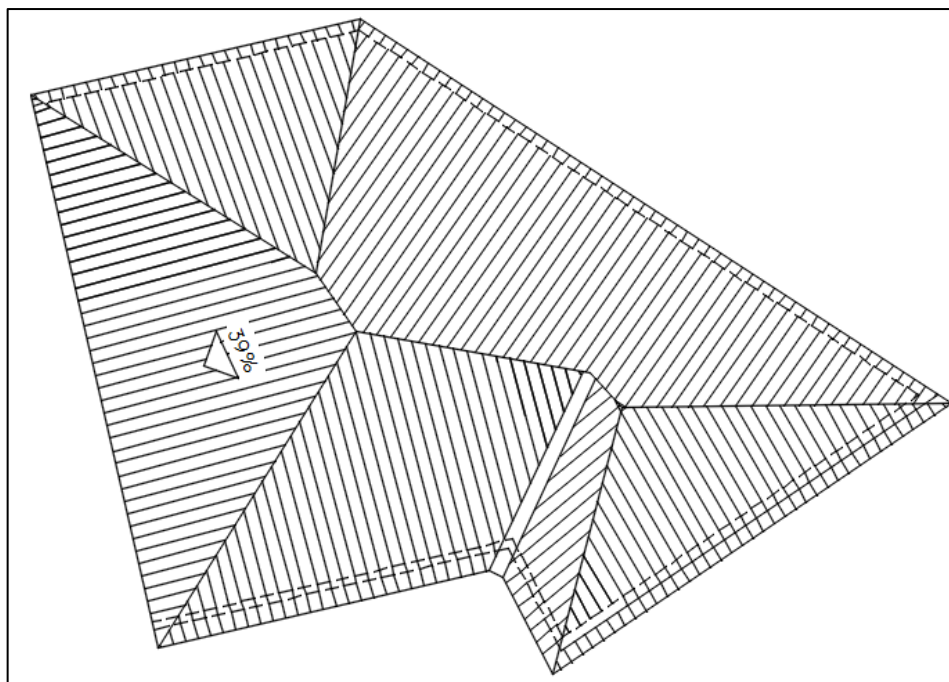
Detalhe do caimento do telhado para posicionamento das placas coletoras. (DOS AUTORES)
